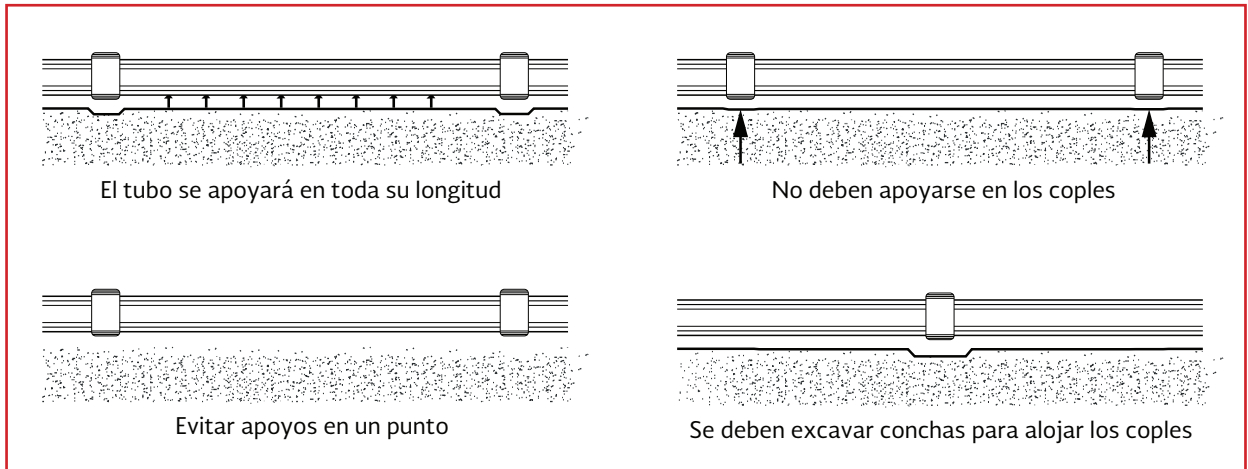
Cama de apoyo tipo A para tubos en zanja
